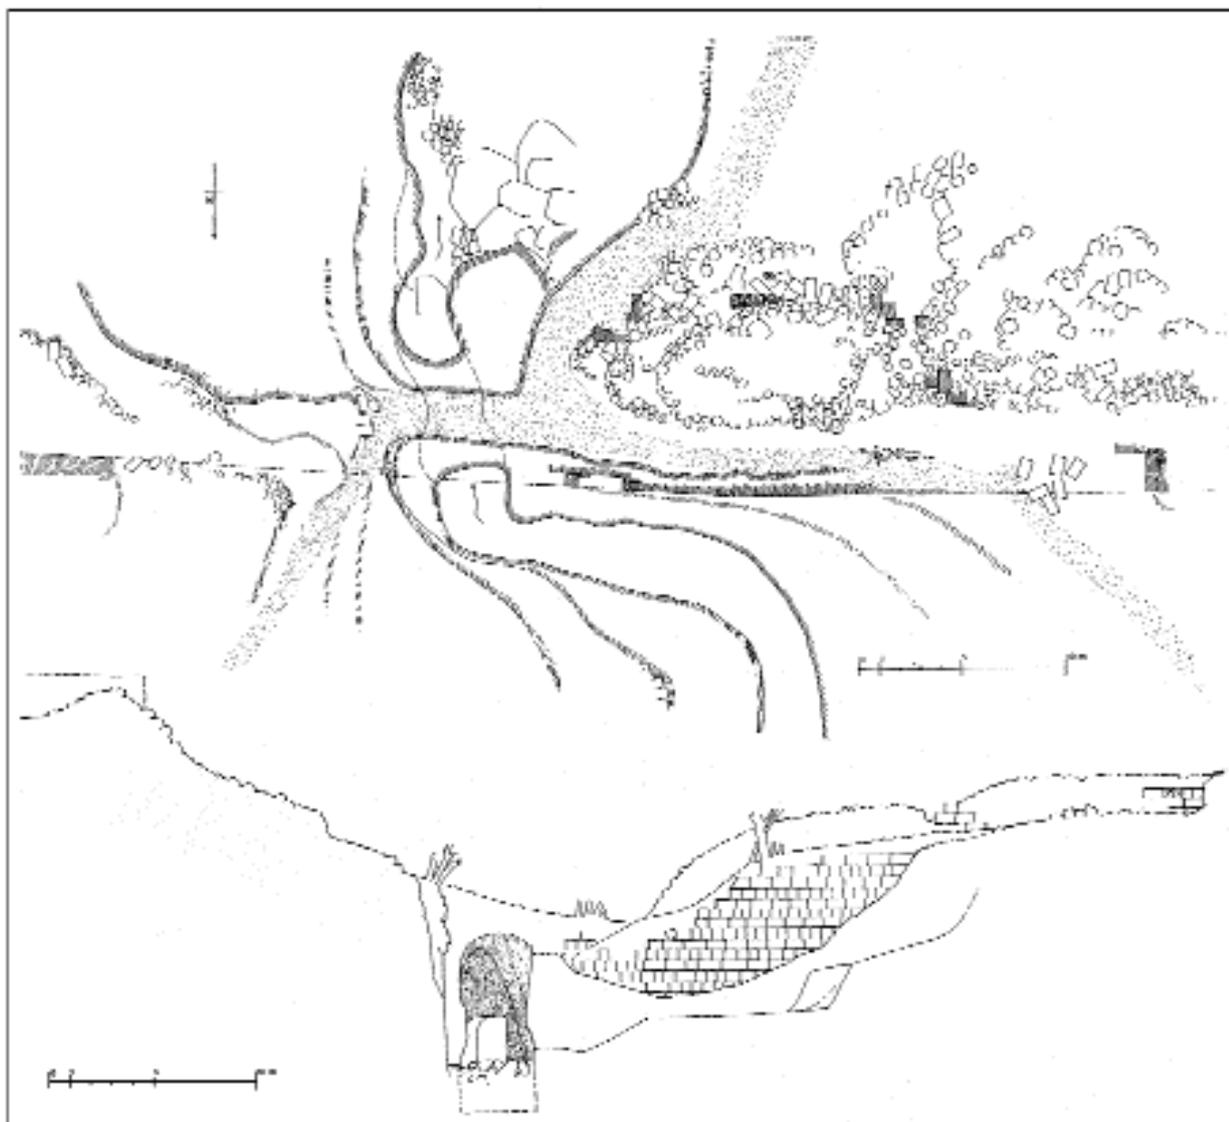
Ponte Terra a Valle Vittoria presso Cerveteri, pianta e prospetto a monte.
